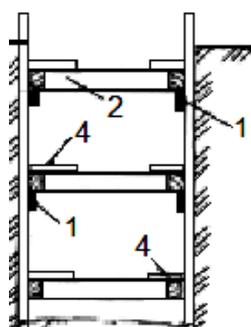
Горизонтальное крепление стенок прямоугольной траншеи для укладки ПВТНК из ВЧШГ вразбежку
